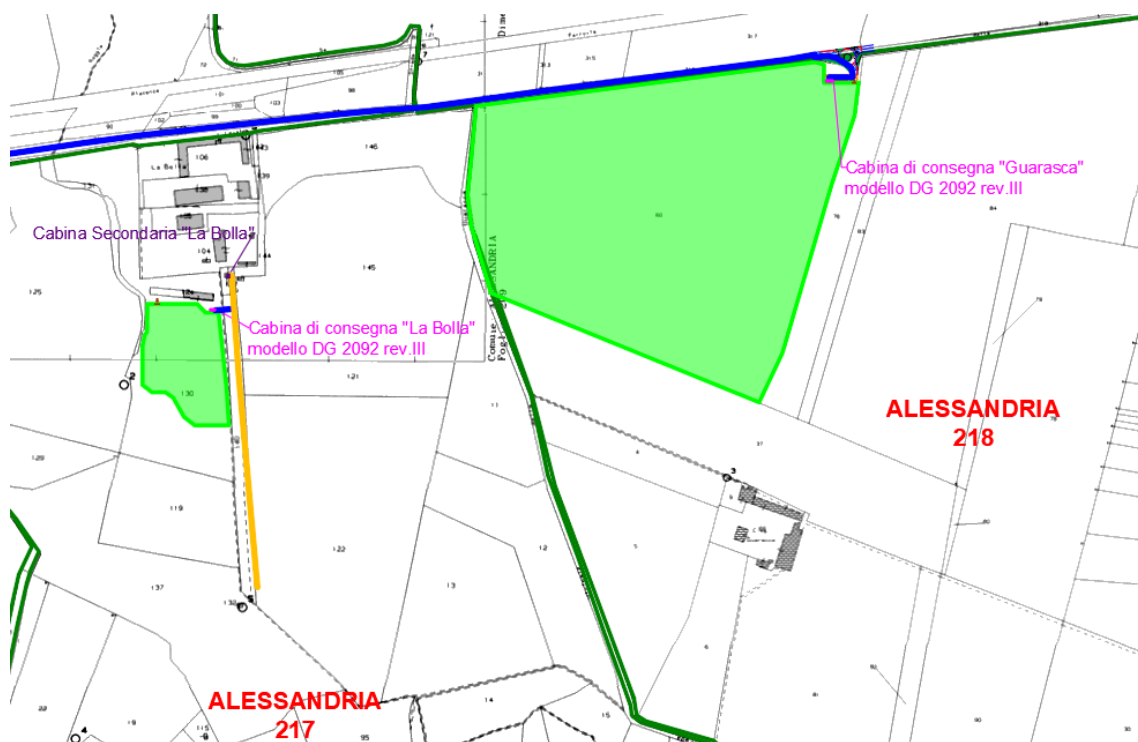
Sovrapposizione delle aree di progetto su planimetria catastale (Comune di Alessandria, ff. 217-218)
